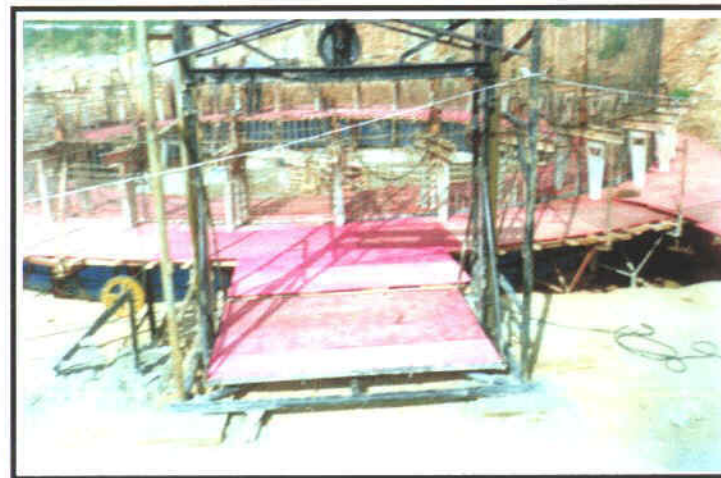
Vista da colocação do equipamento para forma deslizante.
